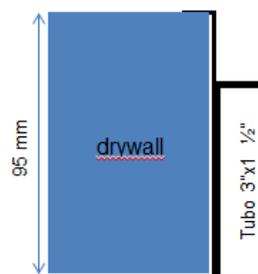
Capa em U entre fechamento de drywall e tubo do painel de vidro.
